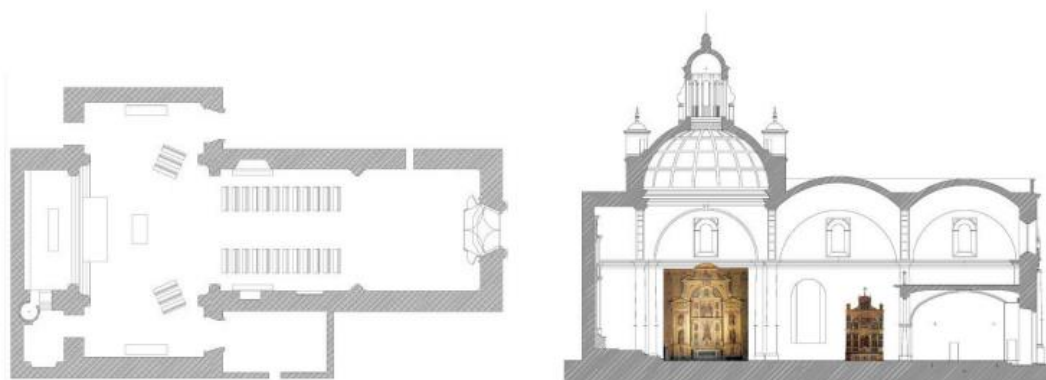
Planta (esq.) e corte transversal da igreja La Anunciación, Sevilha [31]
